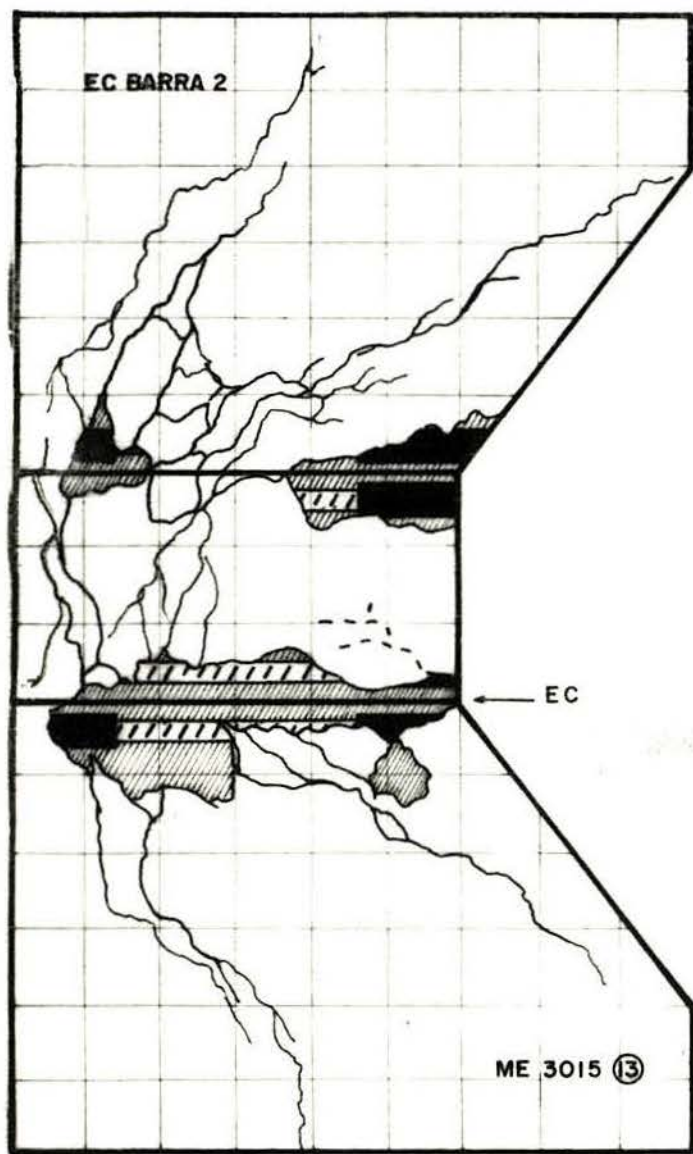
Fissuração dos CP ME 3015
